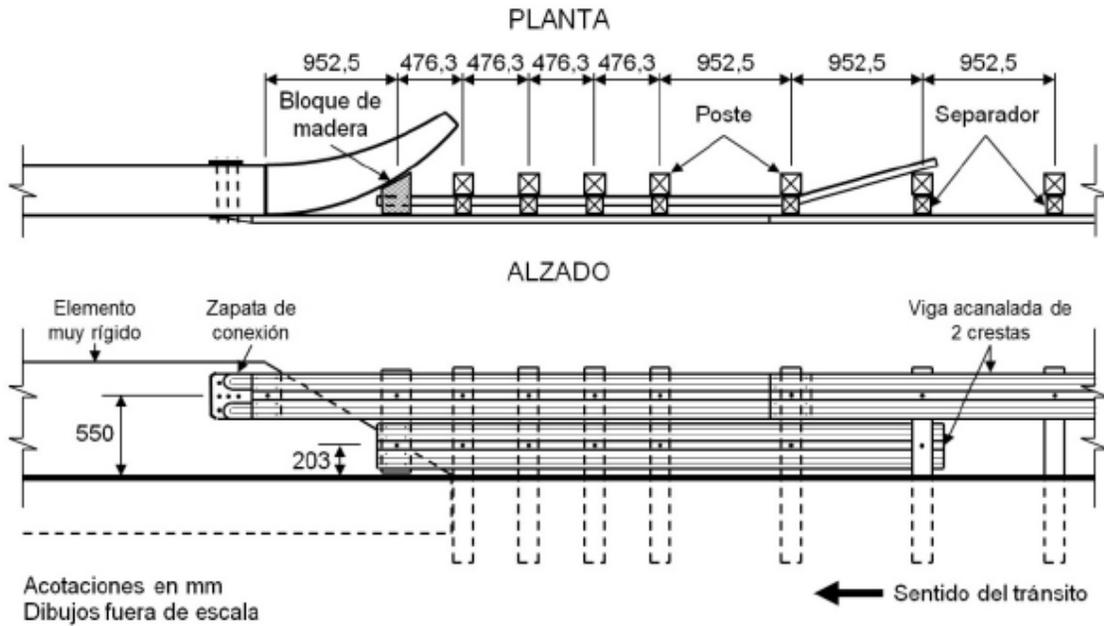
Transición de barrera metálica de doble bandas a muro curvo
